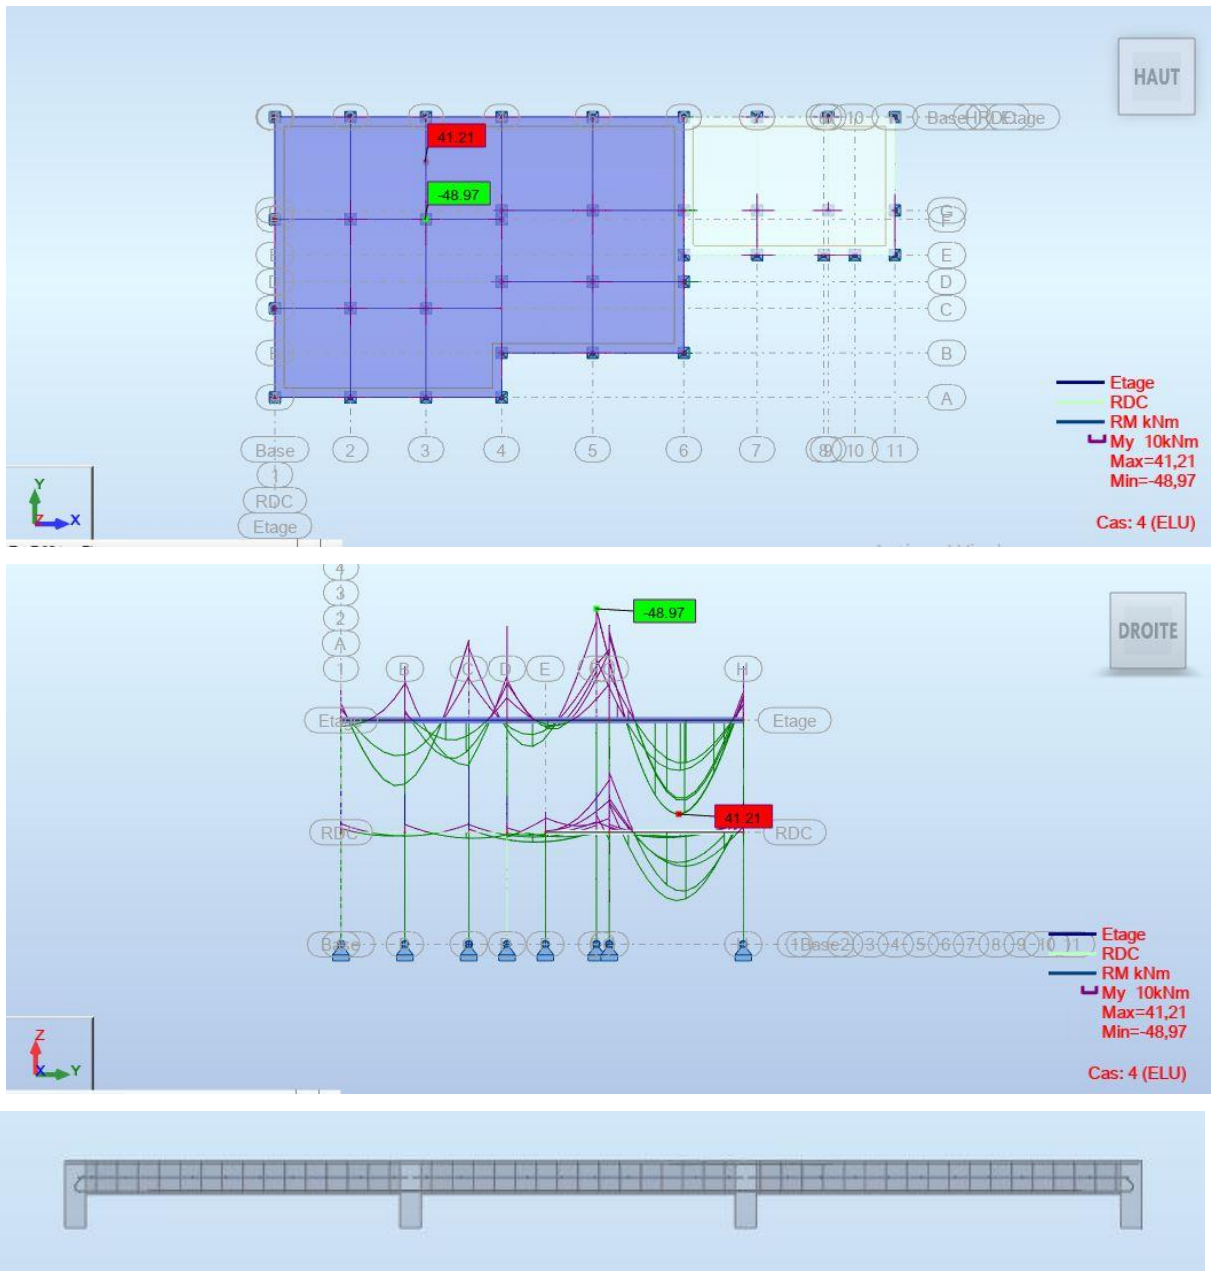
La poutre la plus chargée de l'ouvrage.
